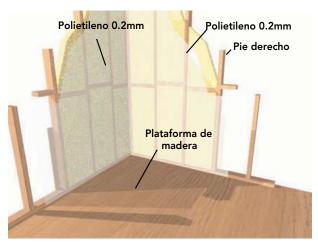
25: Fijación de barrera de vapor por el paramento interior del tabique perimetral, luego de colocada la aislación térmica.
